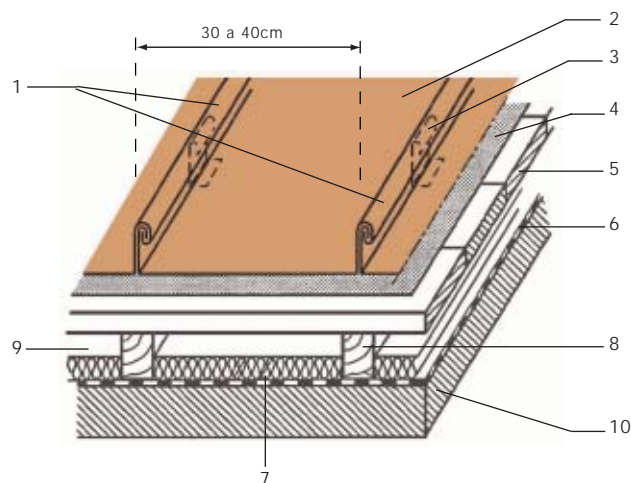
A - Suporte base de madeira maciça (macho e fêmea) sobre sarrafos corridos, fixados sobre estrutura de concreto armado da cobertura.
